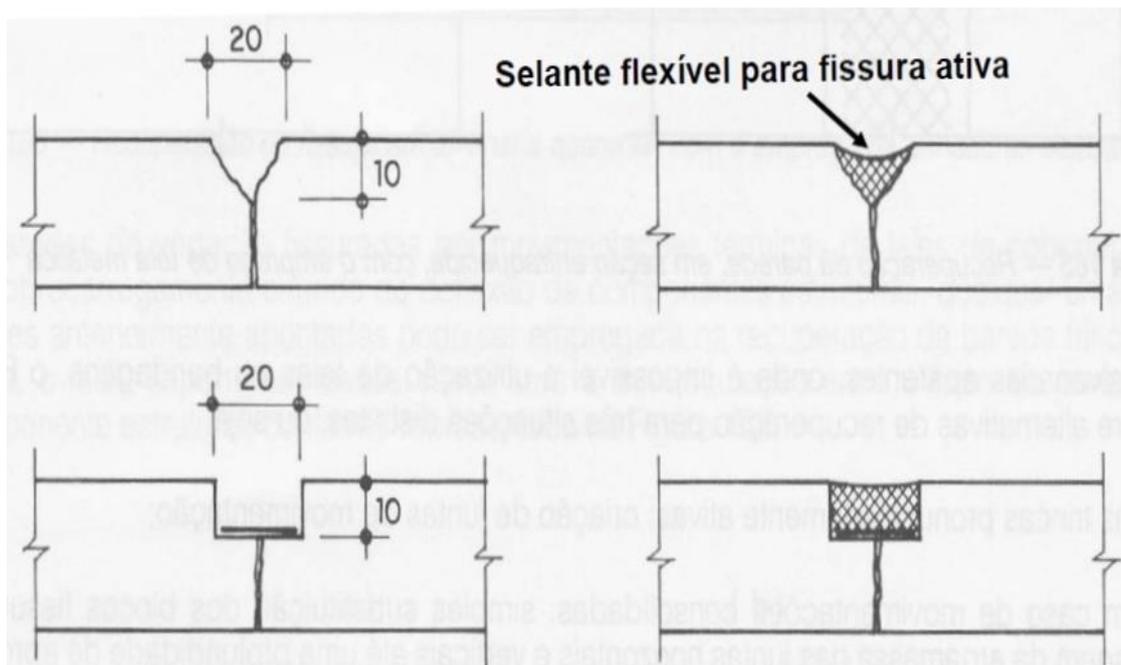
Modo de recuperação de fissuras recomendado.
